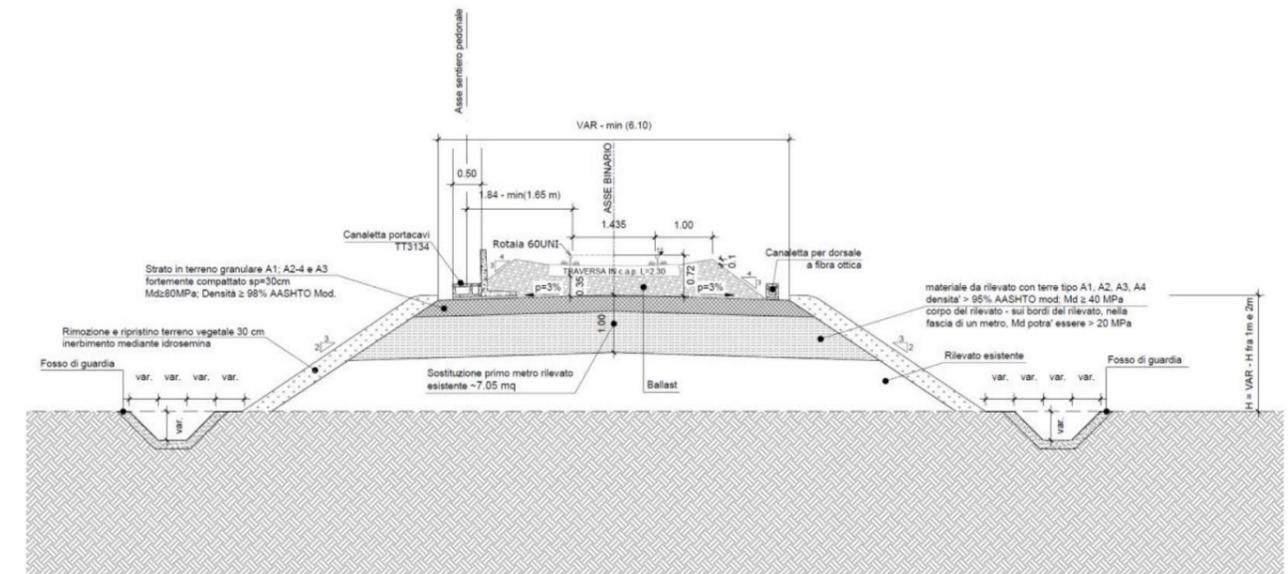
Sezione tipo 1 per rilevati di altezza inferiore a 2,00 m.
